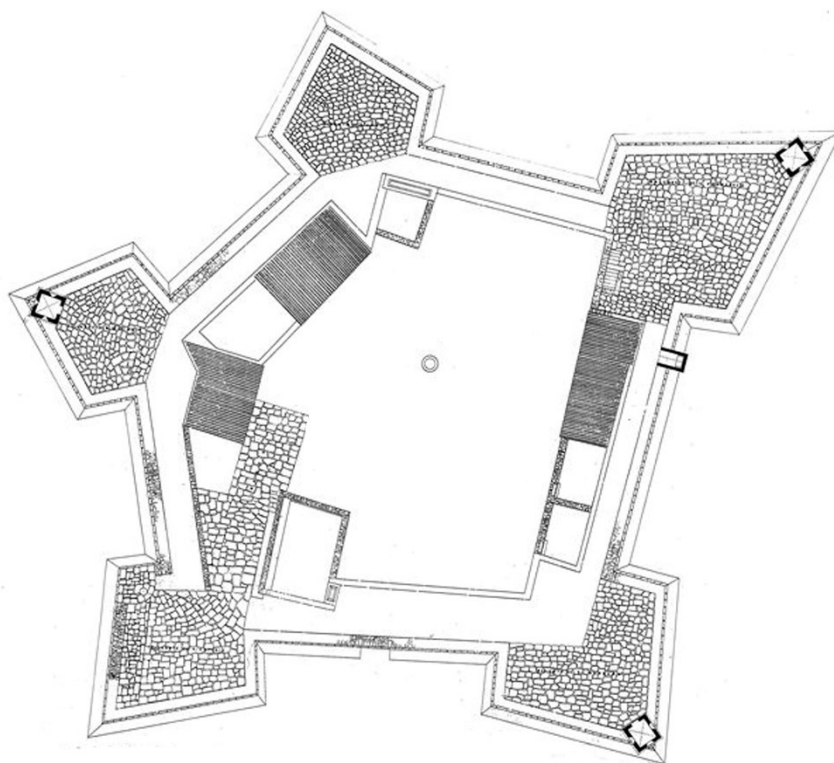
Planta do Forte de São João Batista de Vila do Conde
